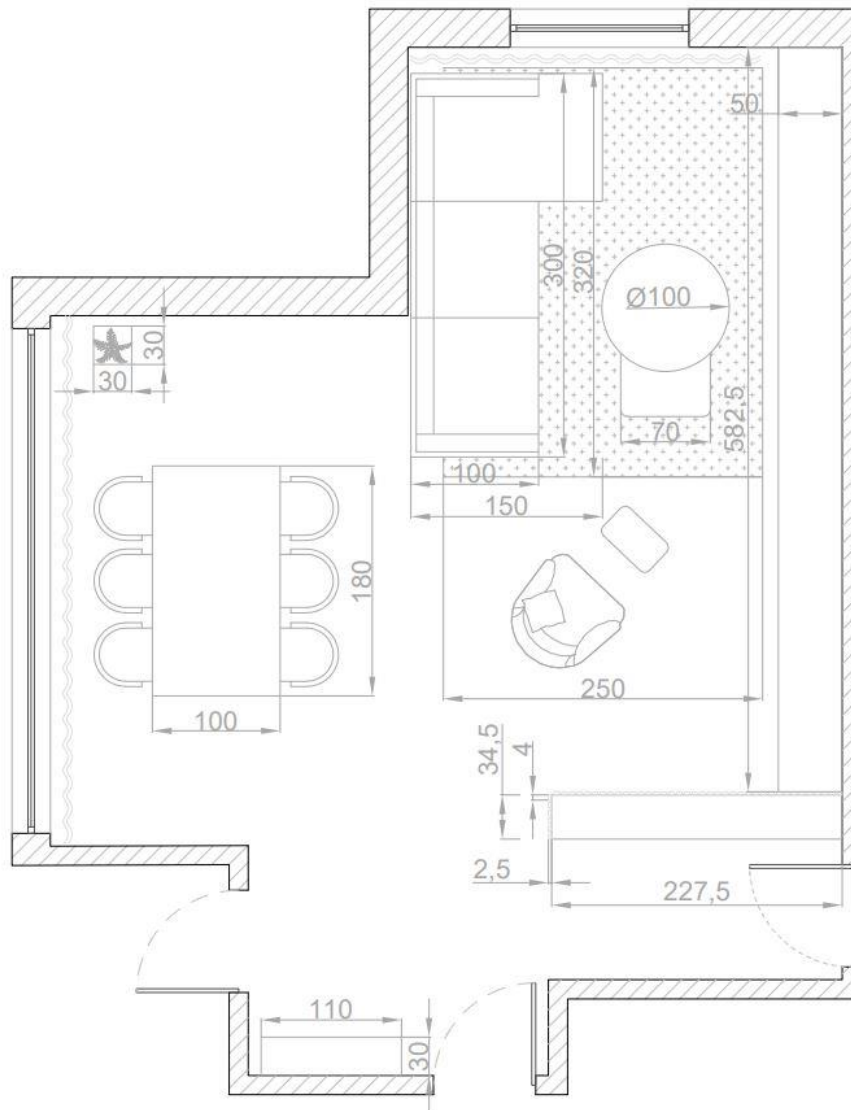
Planta de Equipamento Cotada do Hall de Entrada e Sala
